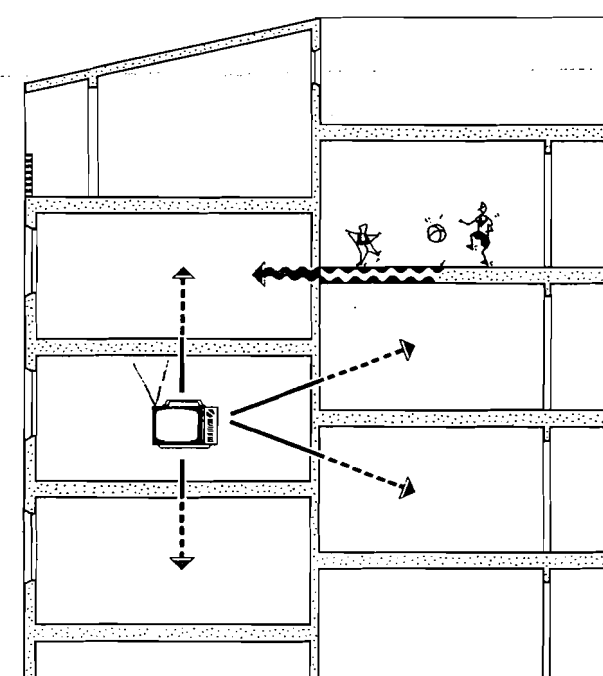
Denah bangunan apartemen yang secara akustik cukup baik.
